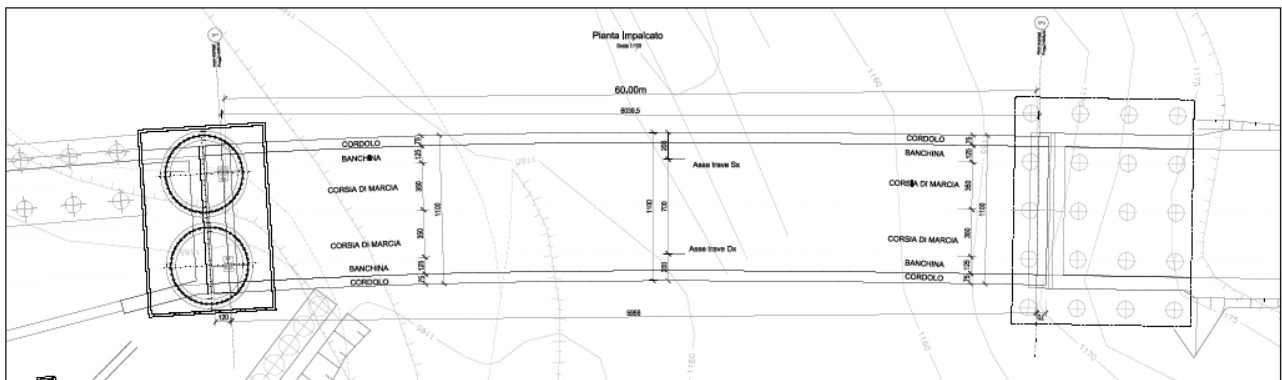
Ponte Bigontina – Stralcio planimetrico
